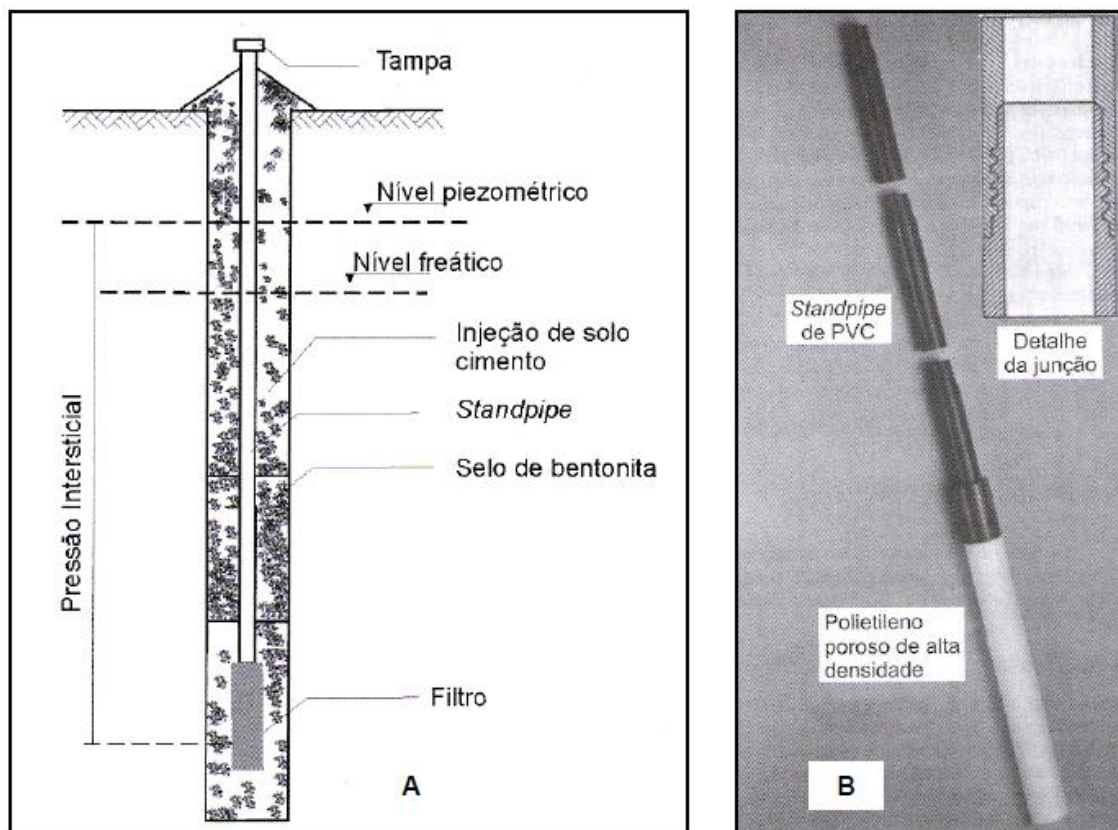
(A) Esquema de um piezômetro standpipe instalado em furo de sondagem; (B) Piezômetro standpipe com filtro poroso, conectado à tubulação em PVC (SILVEIRA, 2006)
